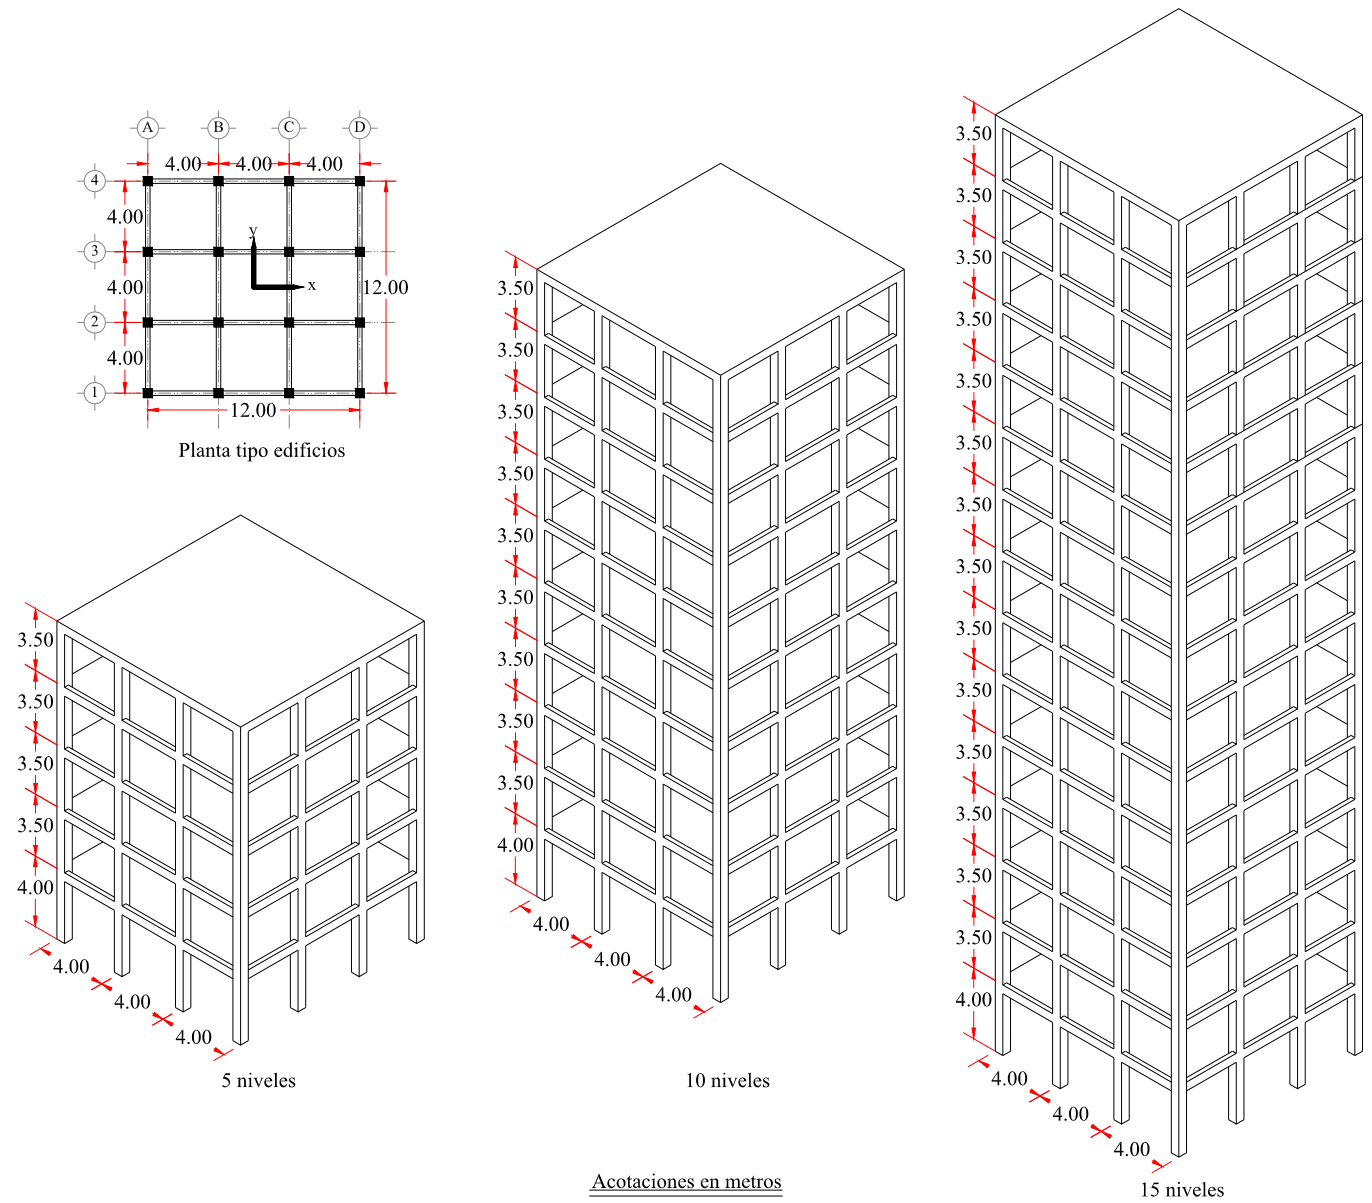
Planta tipo e isométrico de edificios de 5, 10 y 15 niveles (planta cuadrada 12 x 12 metros).
